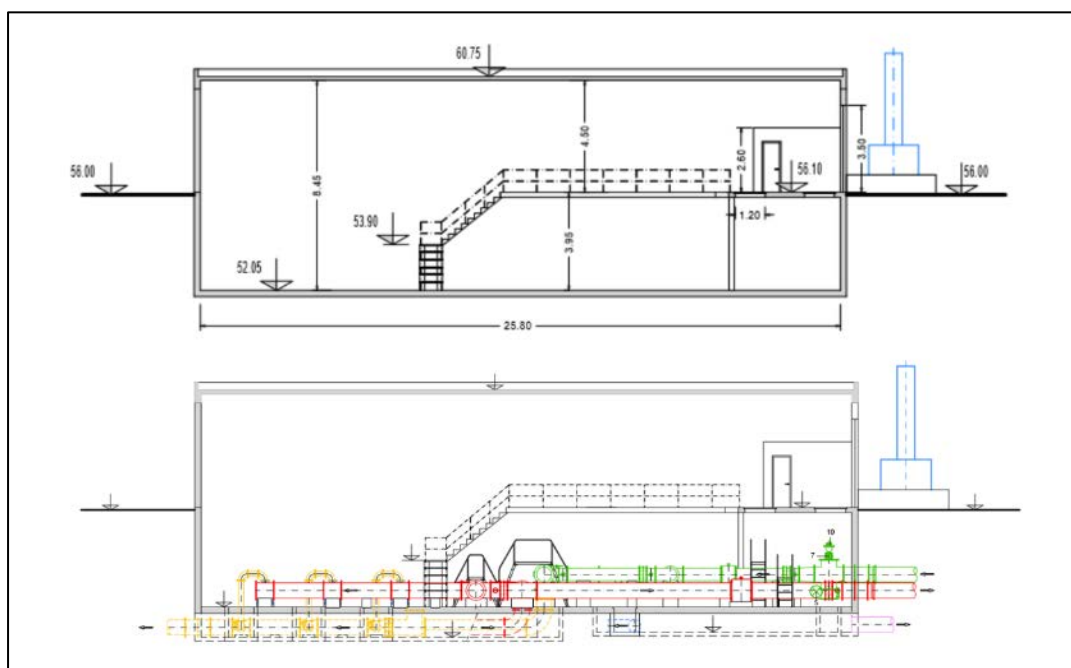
Desenho técnico da câmara de manobra entre as duas câmaras de armazenamento do reservatório. As dimensões são apresentadas na parte superior e os tubos na parte inferior (Fonte: CCA, 2025)
